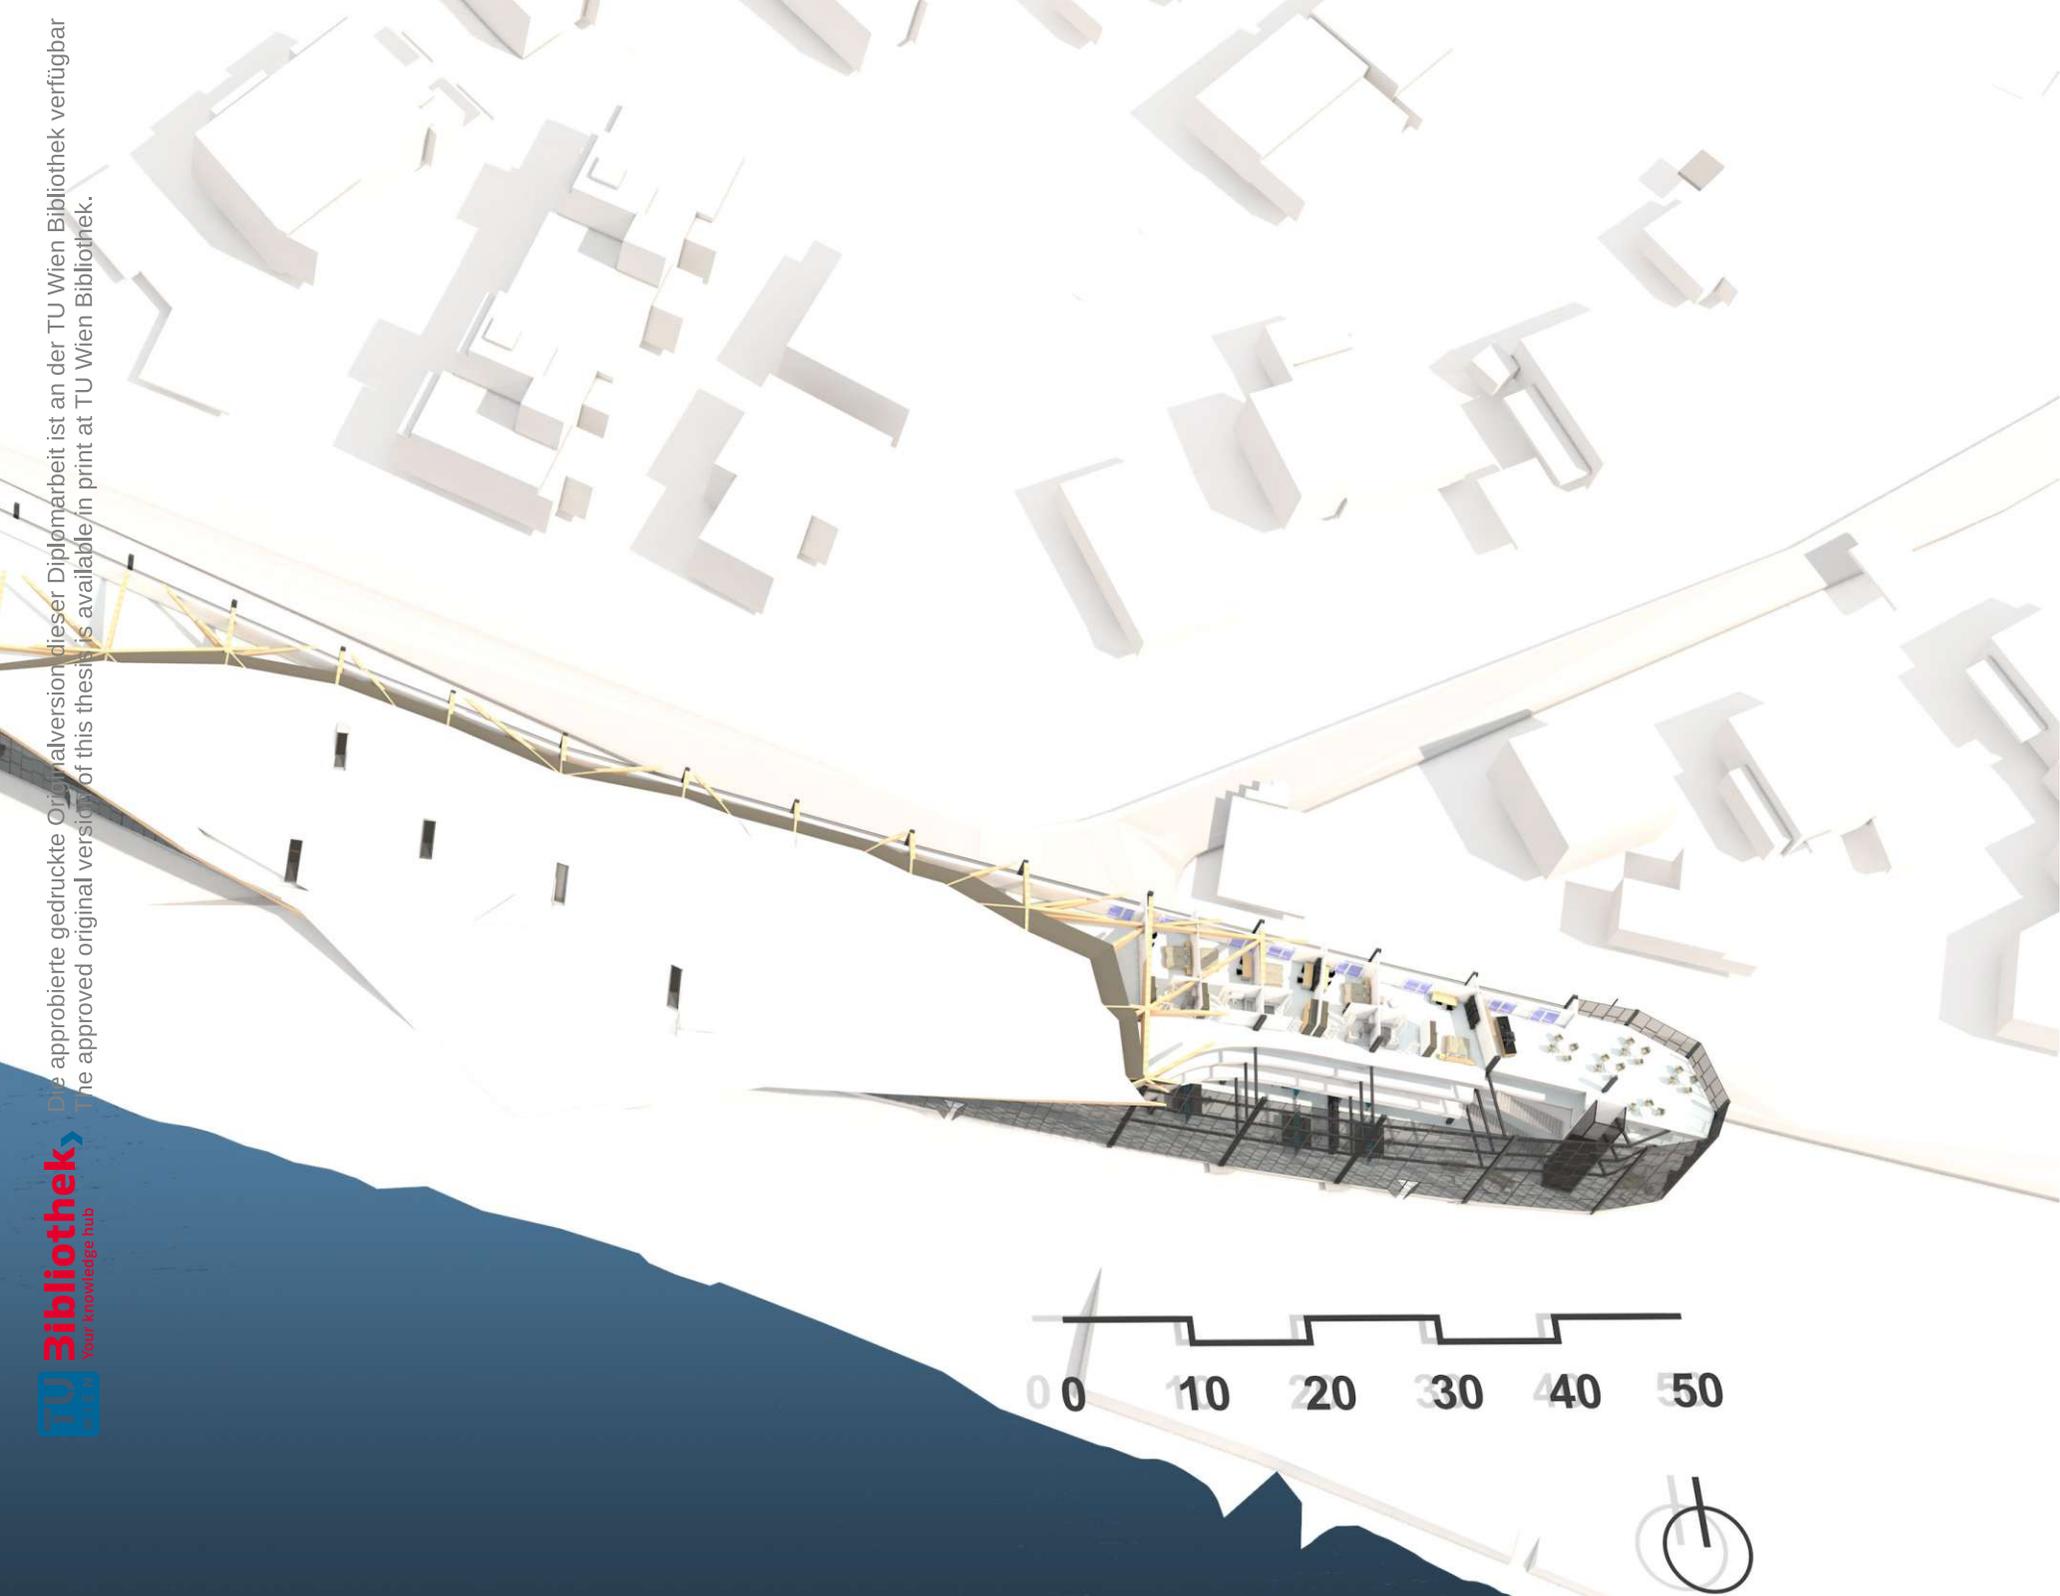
3D Grundriss 3. Obergeschoss
